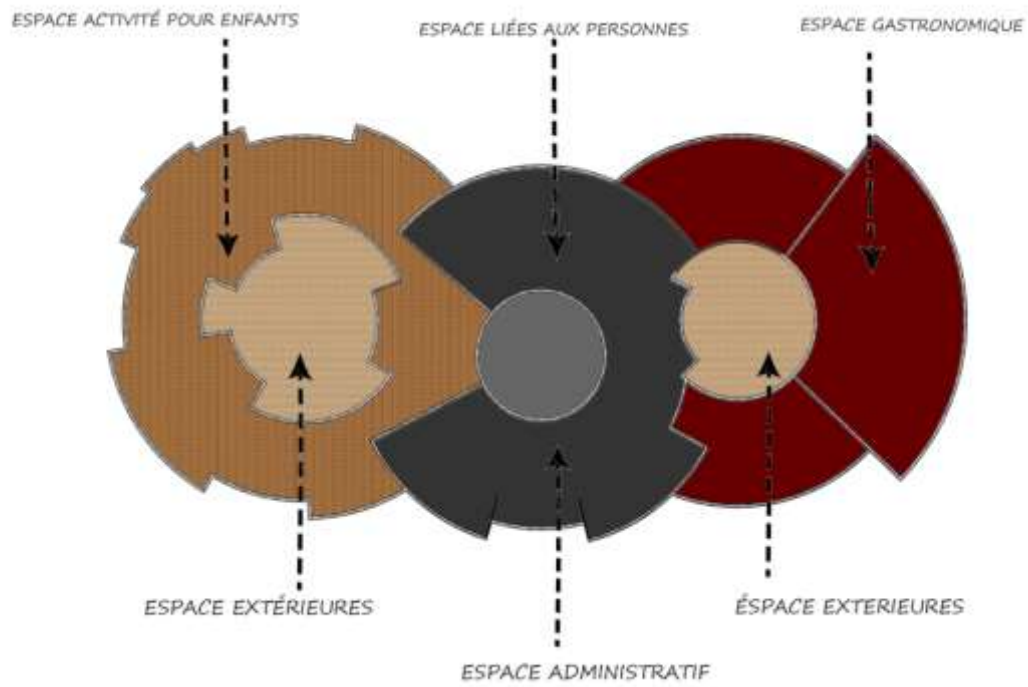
Schéma de plan de rdc (Source : Auteurs)
